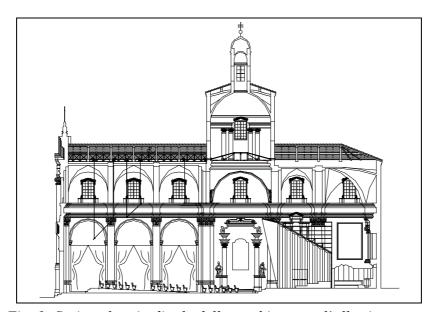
Sezione longitudinale della ex chiesa con l'allestimento previsto.
